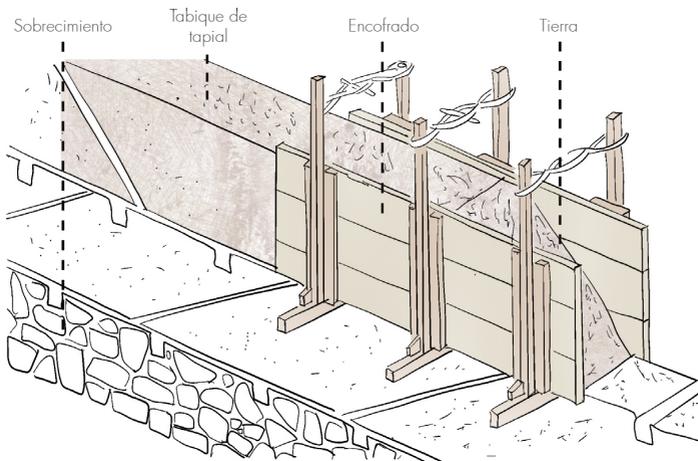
| Encofrado deslizante horizontal. | Fuente: Autoría Propia (2024).
